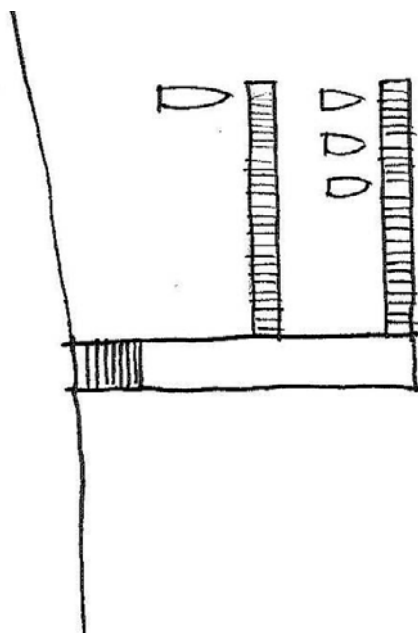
Skiss på utbyggnad av befintlig brygga, enligt utkast till utställningshandling, detaljplan för Torstäva 13:25.
